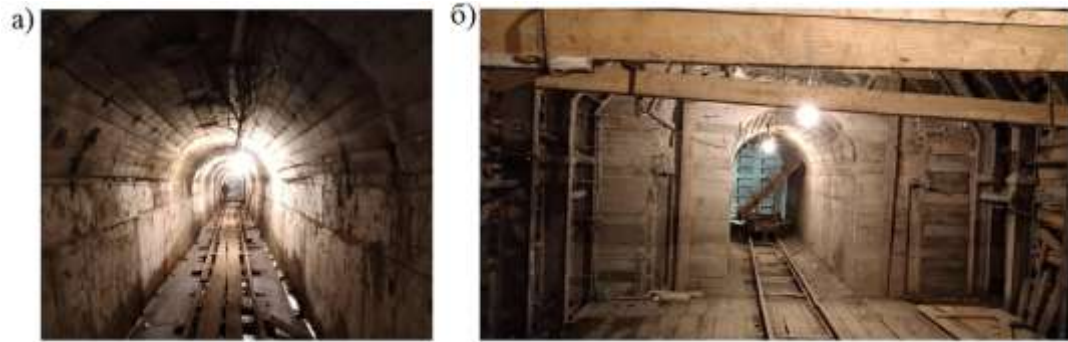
Вспомогательные выработки малого сечения для подхода к: а) камере фильтровентиляционной установке; б) насосной камере
